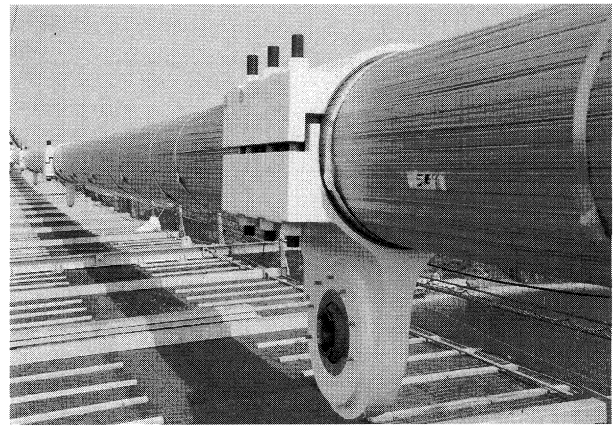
ケーブルバンド(ユニバーサルジョイント定着)
